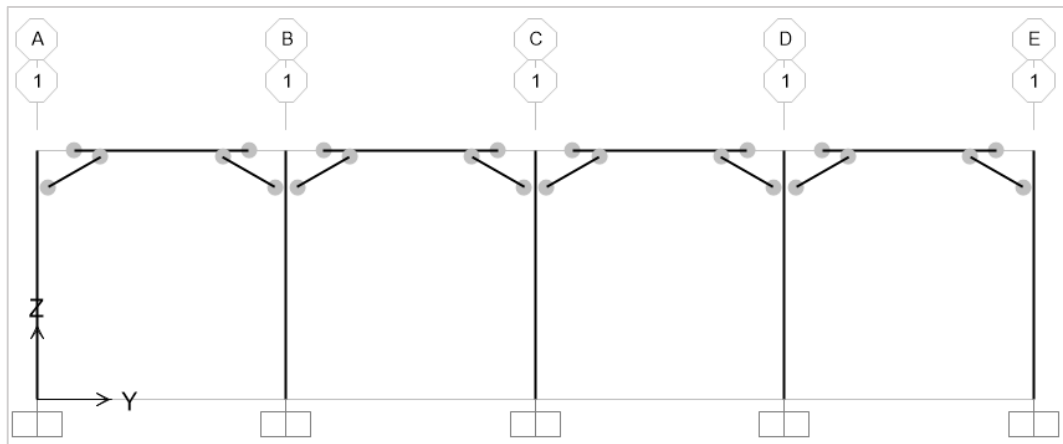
27. Modelo del sistema KBMF considerando conexiones simples entre viga y columna.
